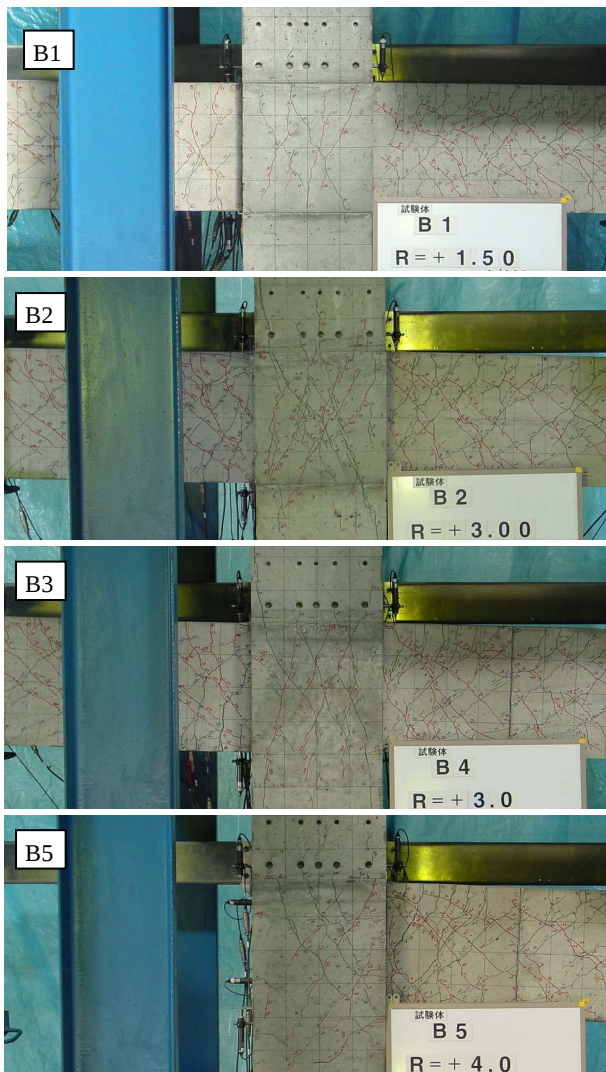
架構実験 ひび割れ発生状況(最大耐力時)
